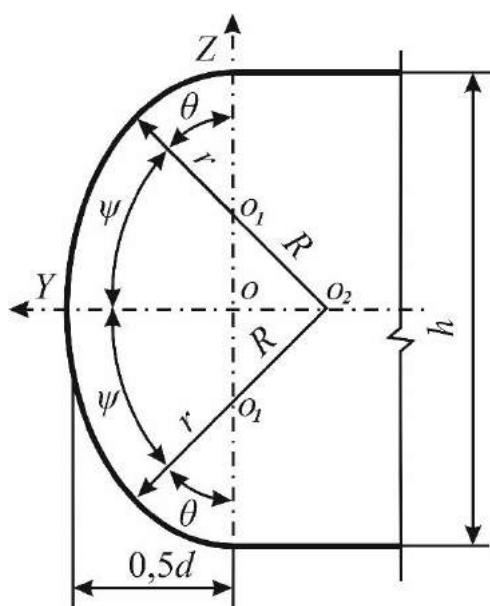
Расчетная схема к построению устойчивой формы забоя горизонтальной подготовительной выработки с помощью радиусов сопряженных закруглений
